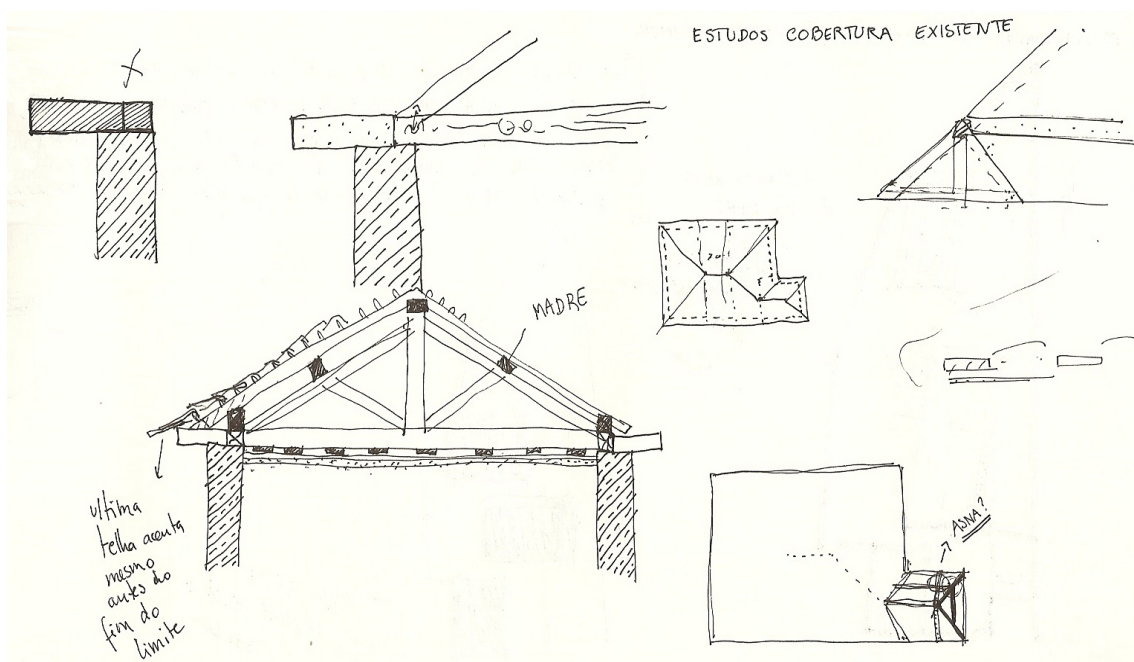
| Esquisso do levantamento da estrutura das coberturas
